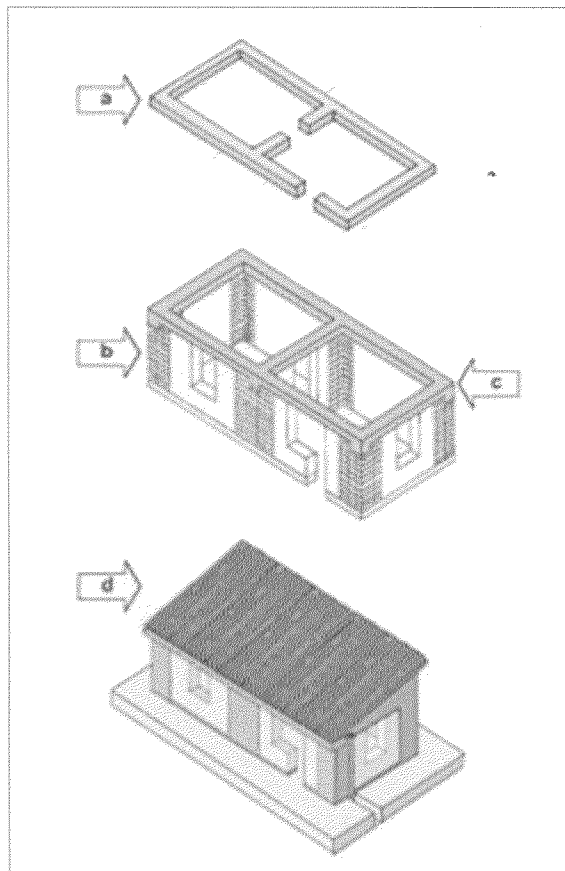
Principales elementos de las viviendas del proyecto (a) cimentación, (b) reforzamiento de los muros de adobe, (c) viga collar, y (d) techumbre con tejas de micro concreto
